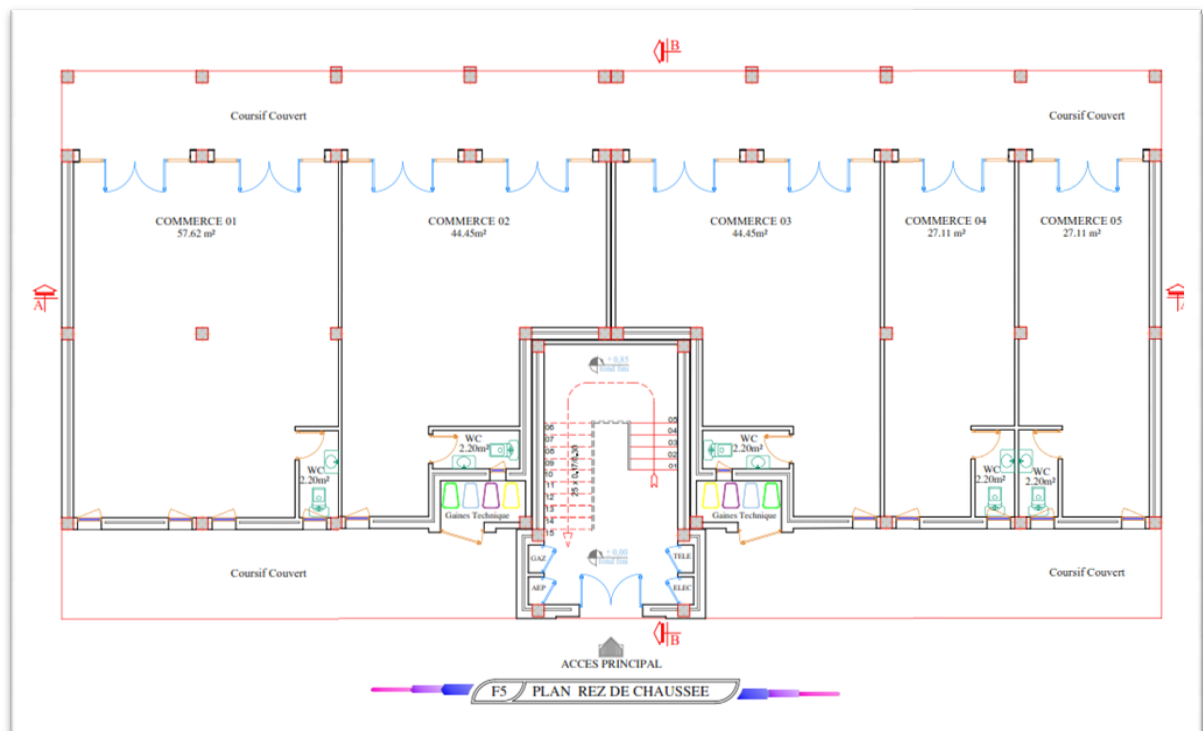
Plan de Rez de Chaussée. Type.01.
